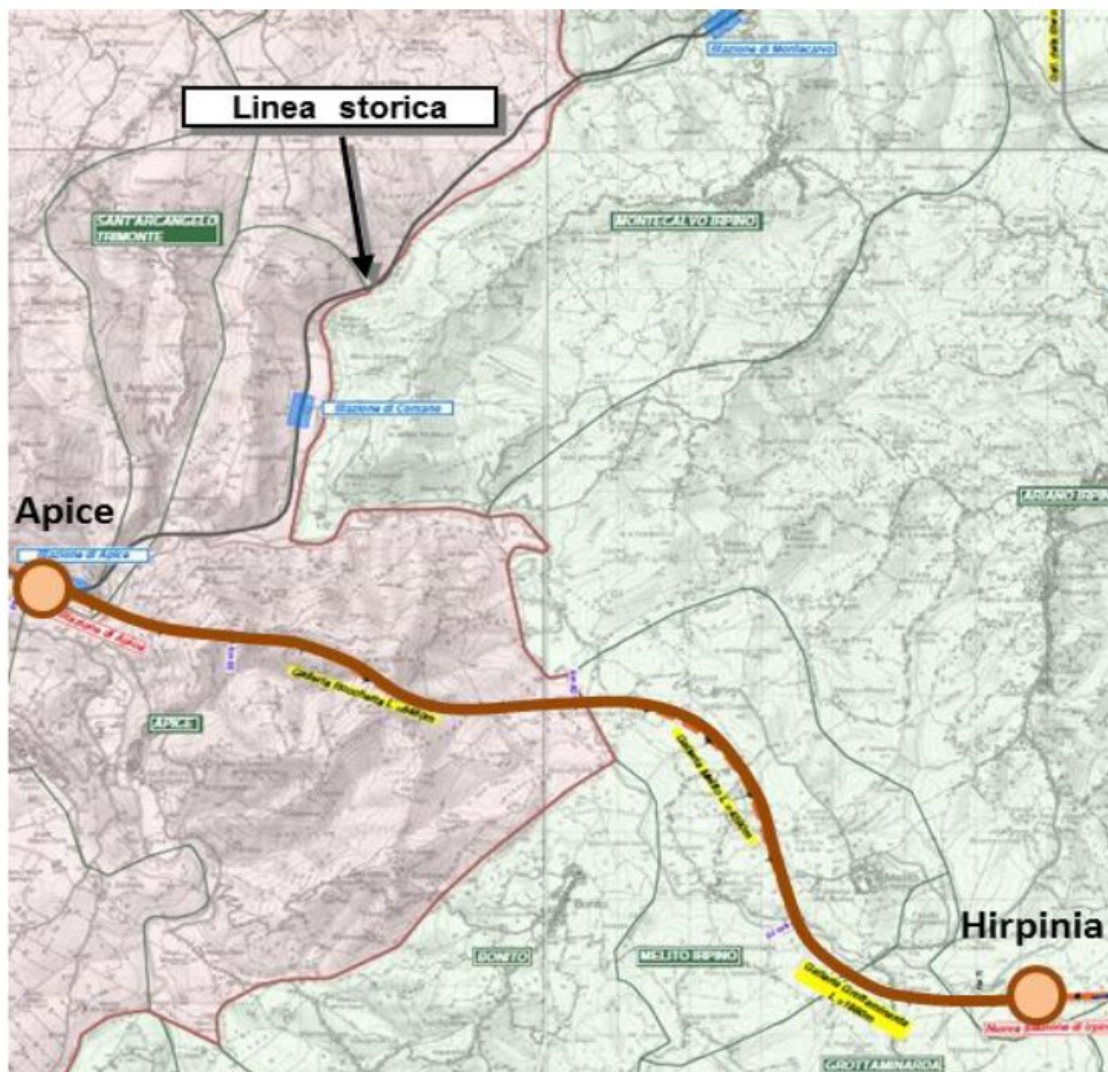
Stralcio planimetrico in ortofoto del tratto ferroviario previsto in PE
